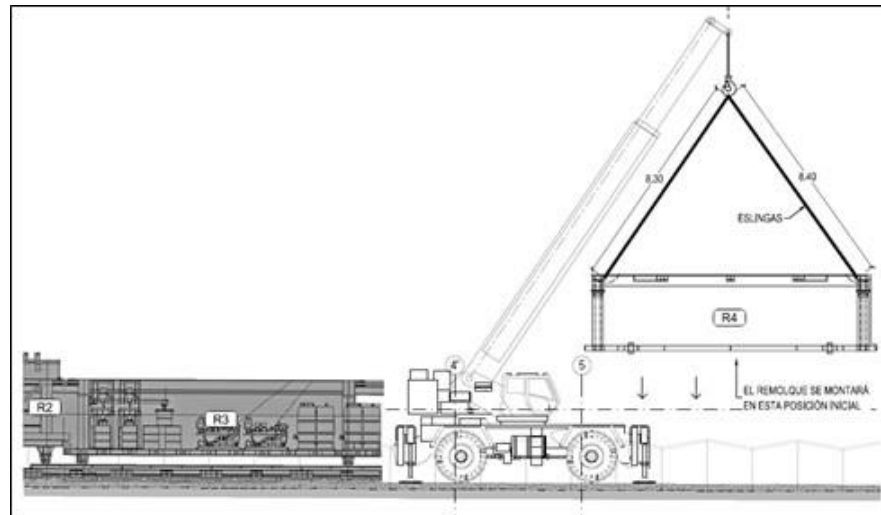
Izado y posicionamiento de remolque (Fuente: Expediente Técnico Final)
